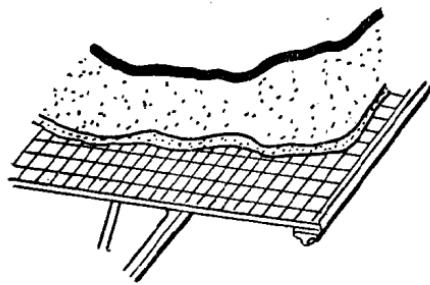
在建筑纸板上铺膨胀蛭石钢筋混凝土
